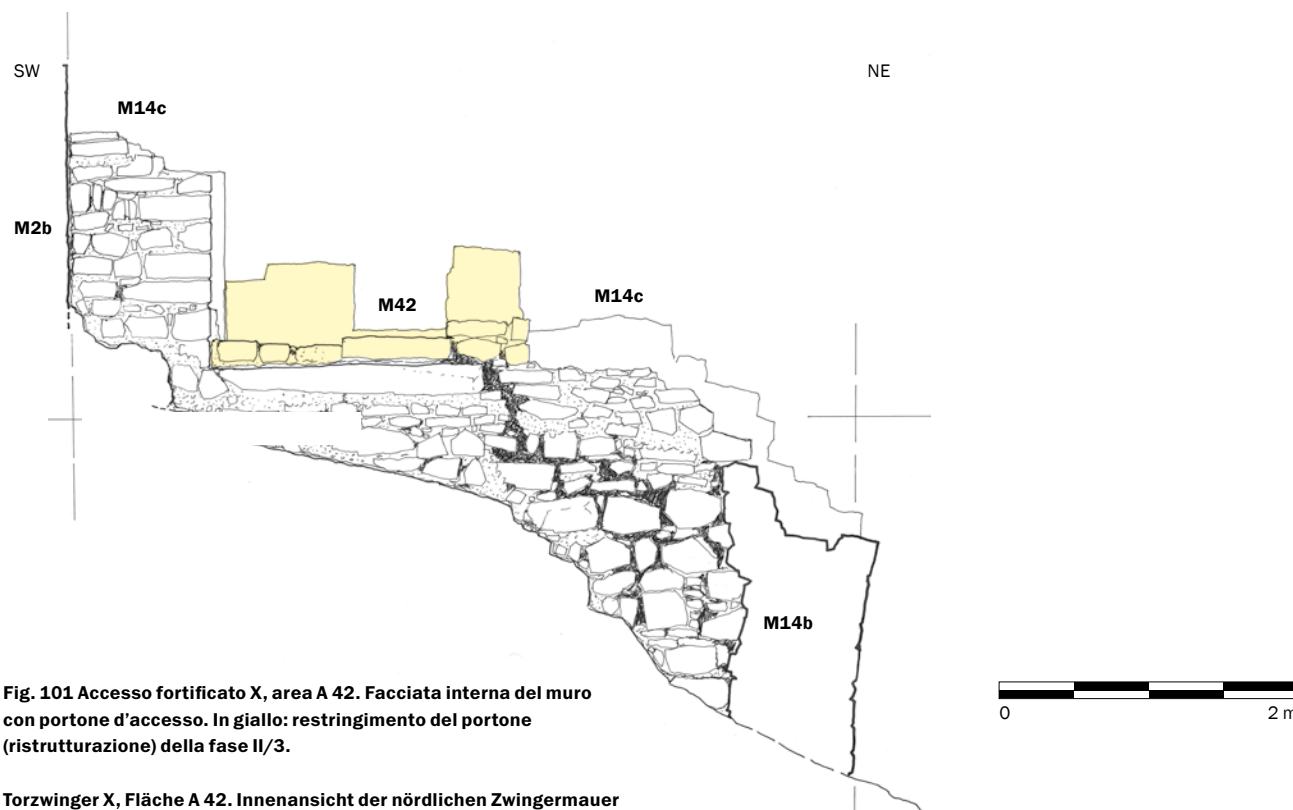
Accesso fortificato X, area A 42. Facciata interna del muro con portone d'accesso. In giallo: restringimento del portone (ristrutturazione) della fase II/3.
